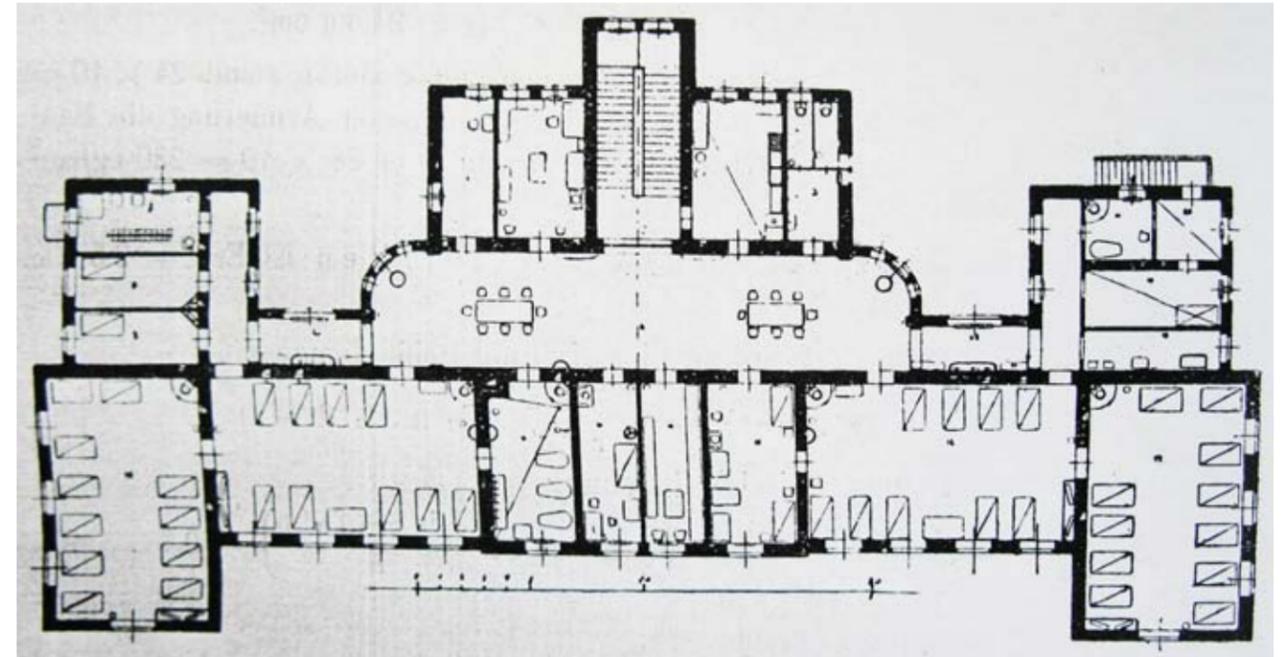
Grundriss Aufnahmepavillon der Anlage Steinhof
